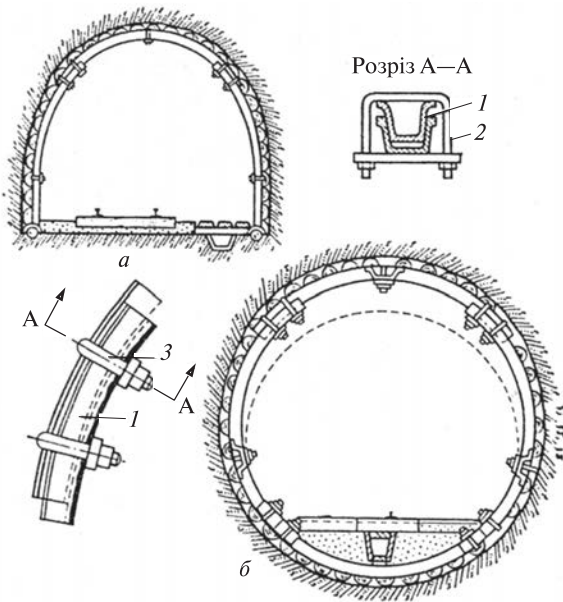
Металеві кріплення зі спецпрофілю: *а* — арочне податливе; *б* — кільцеве податливе; 1 — верхняк; 2 — з'єднувальний хомут; 3 — болт
